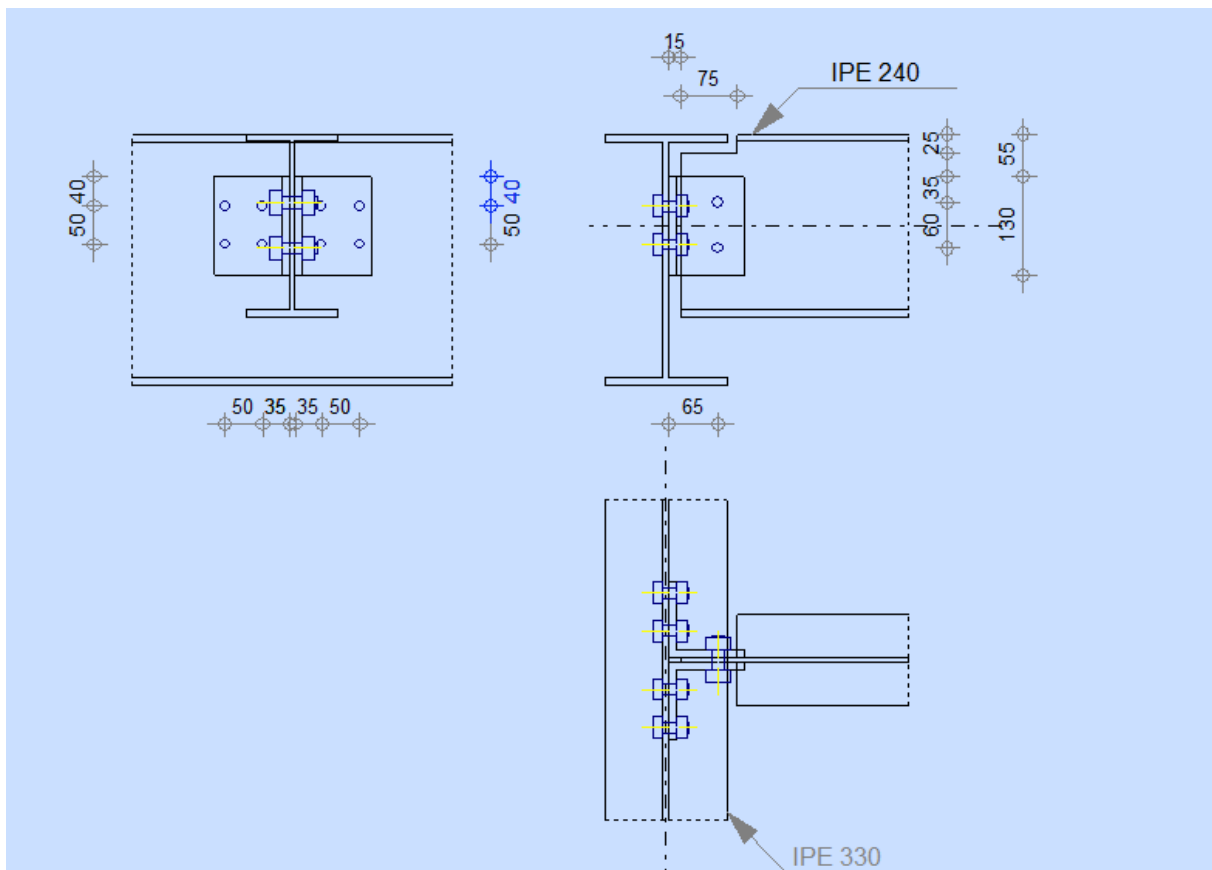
Disposition constructive de l'assemblage poutre – solive.
